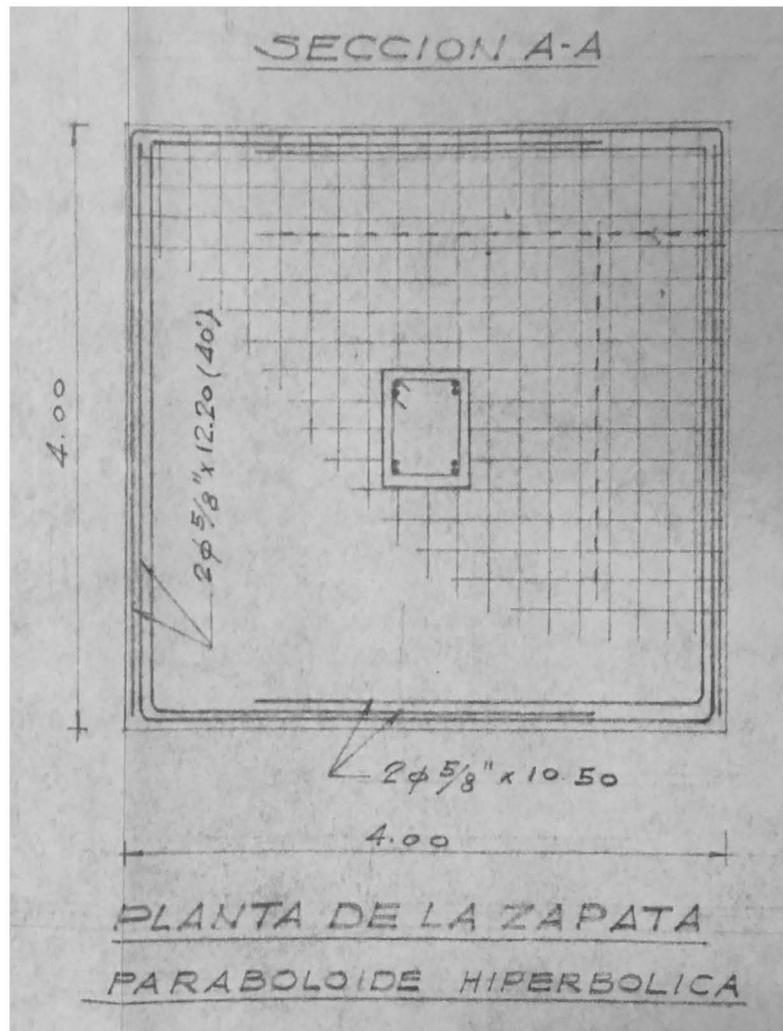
Detalle constructivo zapata de paraboloides hiperbólicas, edificio industrial Bacardi, Fondo Félix Candela, *op. cit.
